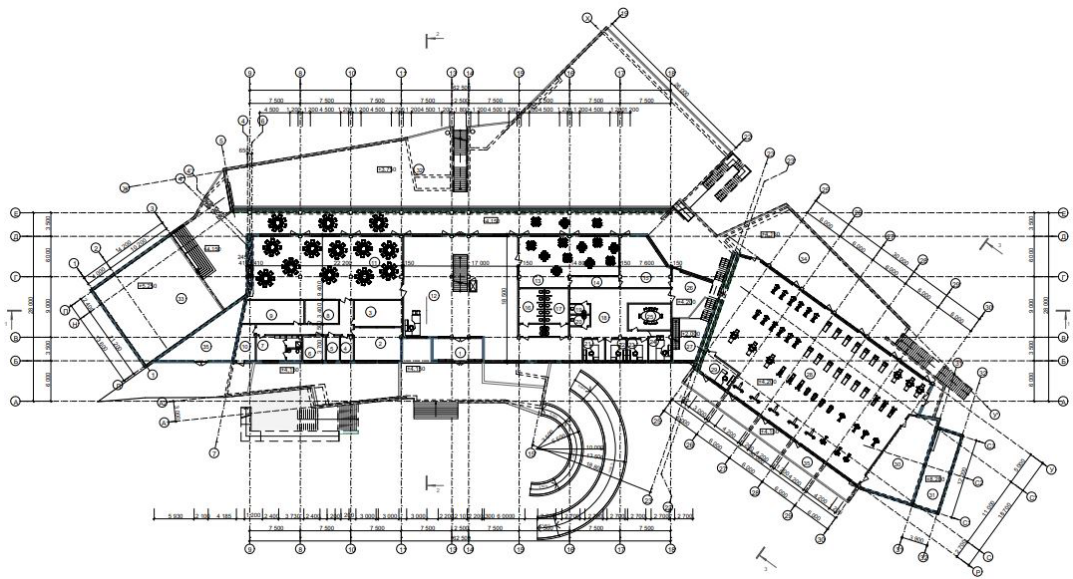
План другого поверху (вхід з головного фасаду)
